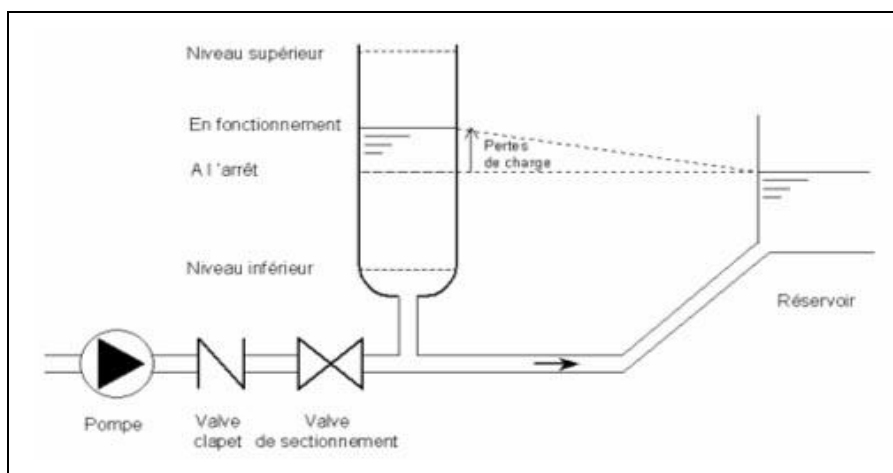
Cheminée d'équilibre sur une conduite de refoulement.
